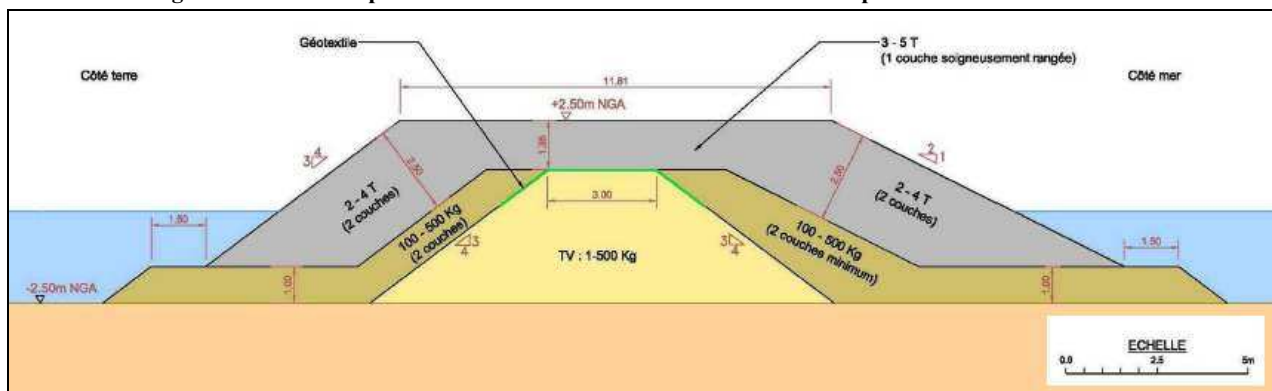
Section-type des brise-lames hauts de la variante n°2 de protection de Palm Beach.
